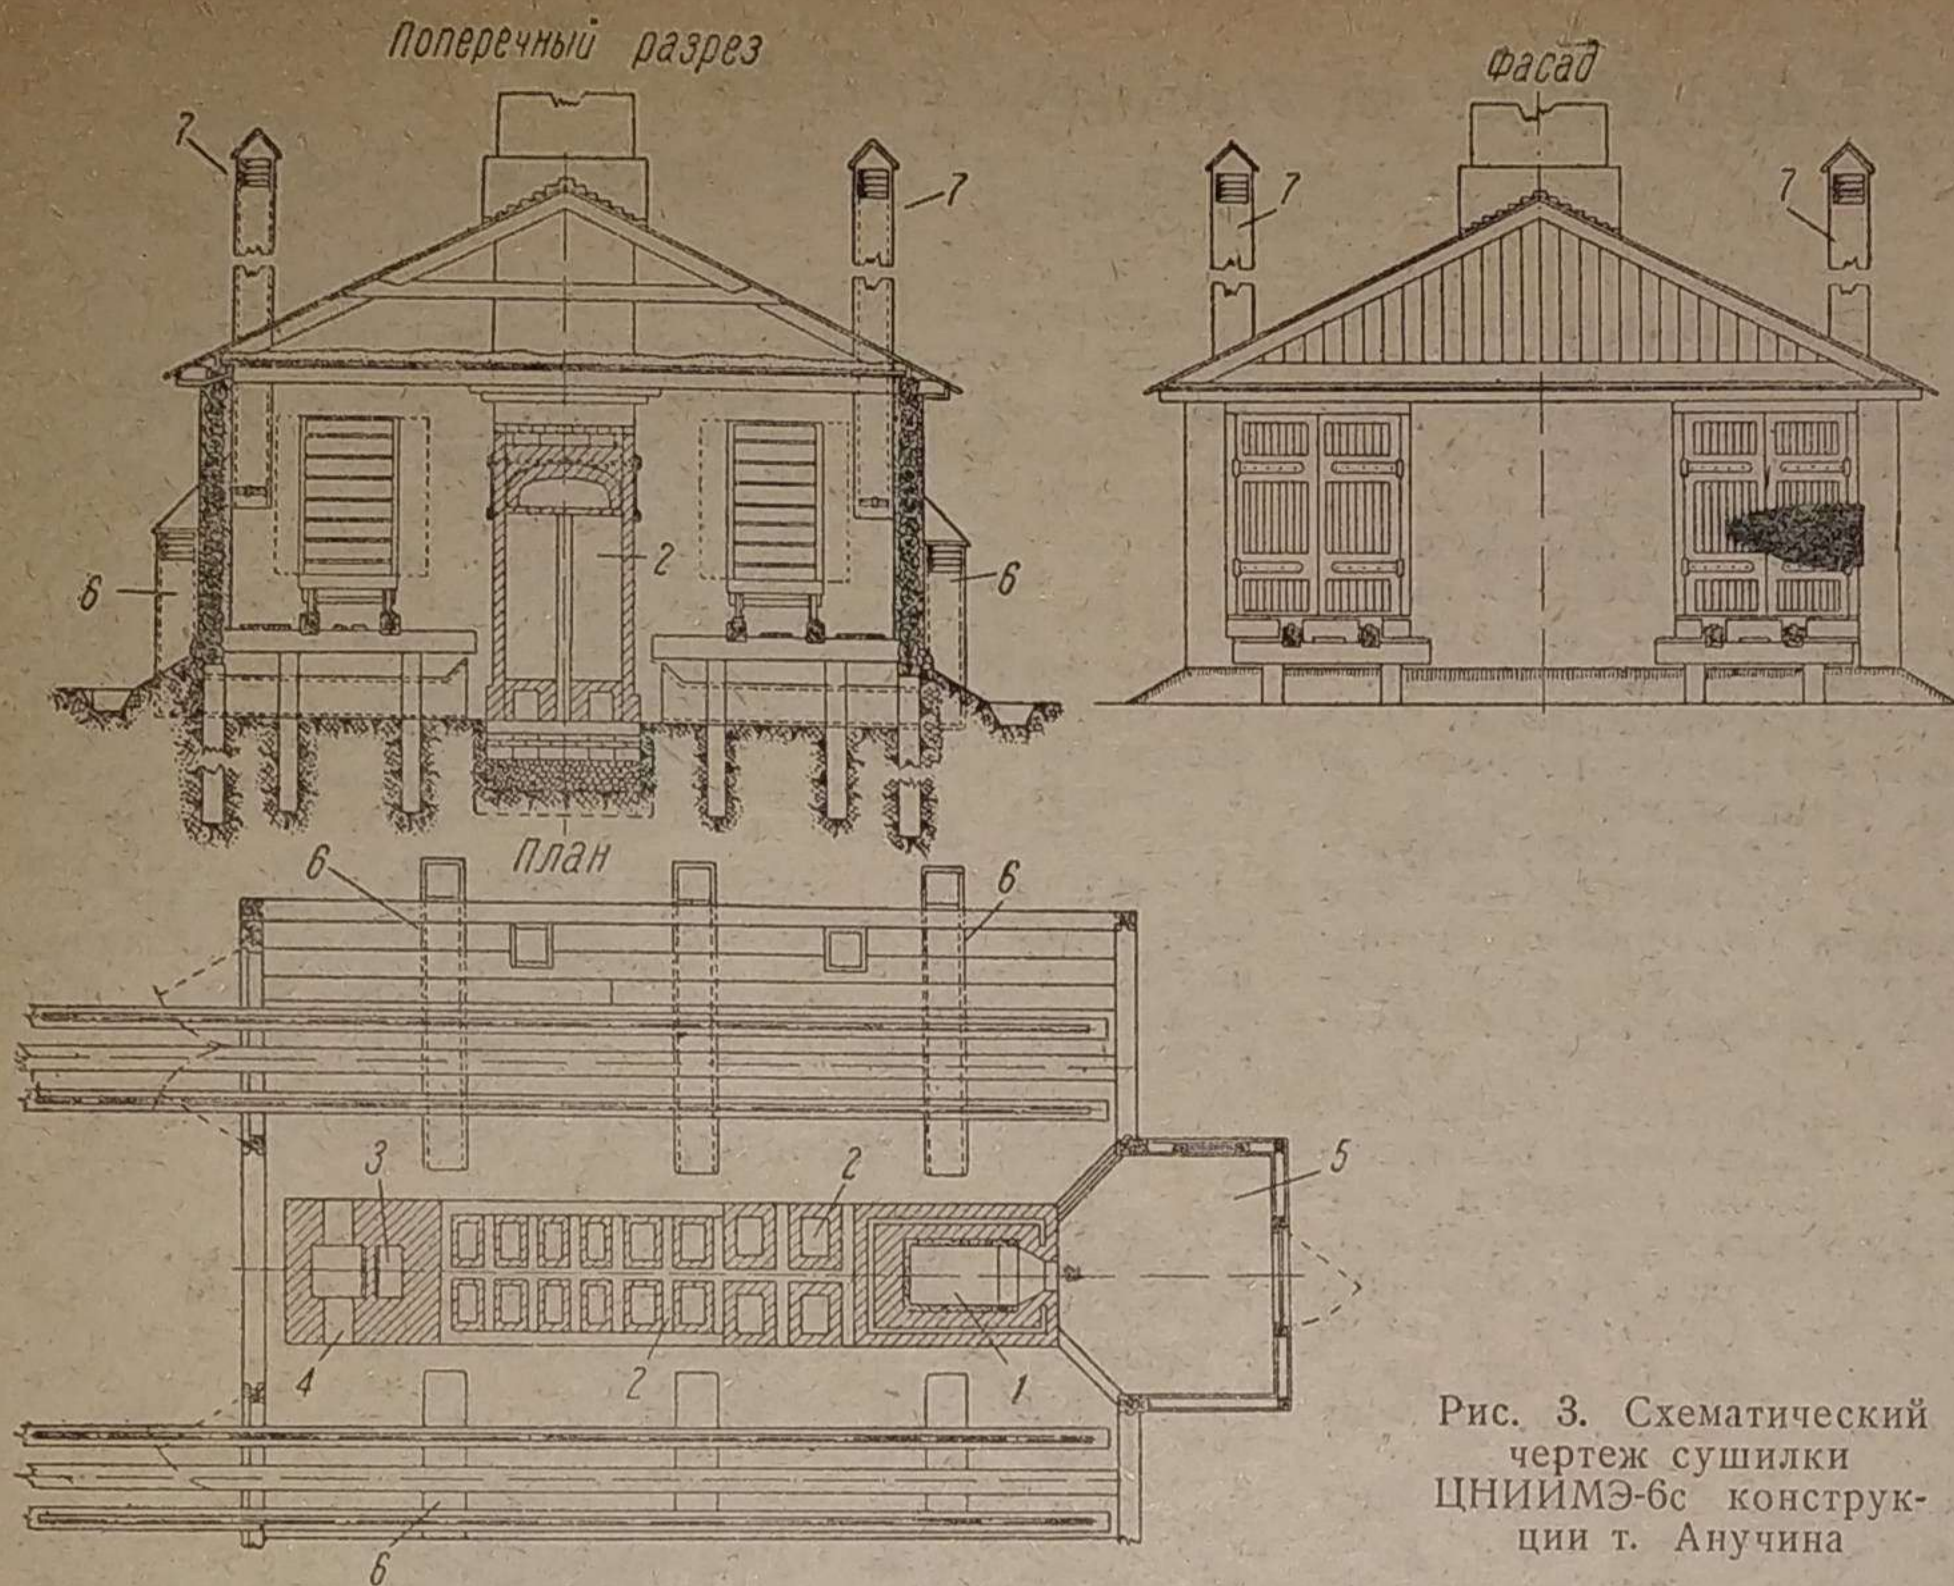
Схематический чертеж сушилки ЦНИИМЭ-6с конструкции т. Анучина
